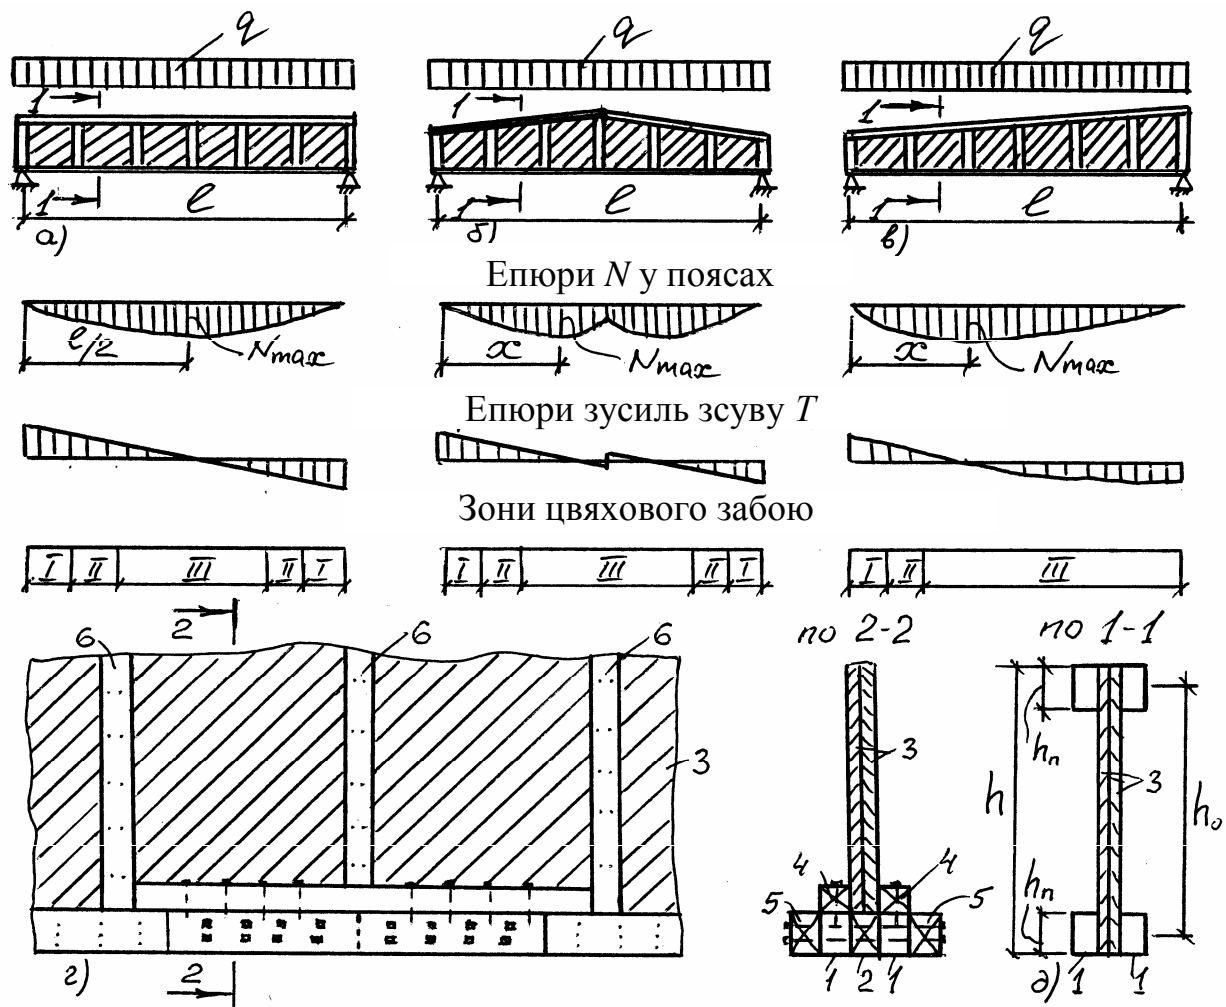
Балки двотаврового перерізу з перехресною стінкою:
